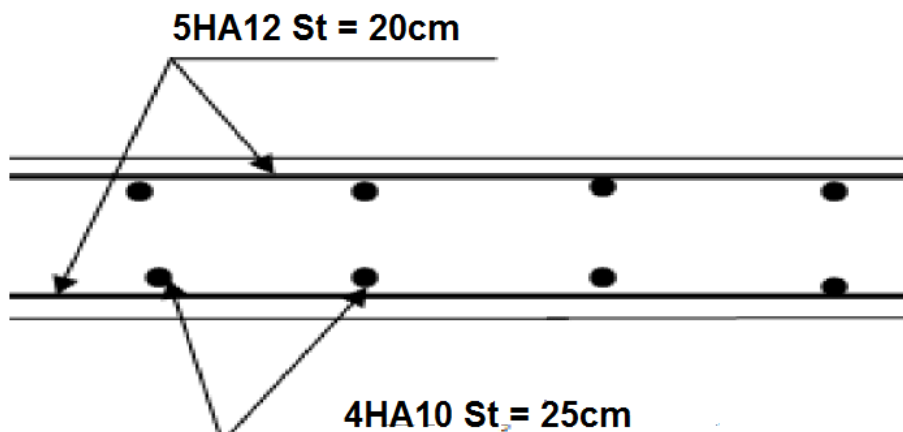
Schéma de ferraille de la dalle pleine
